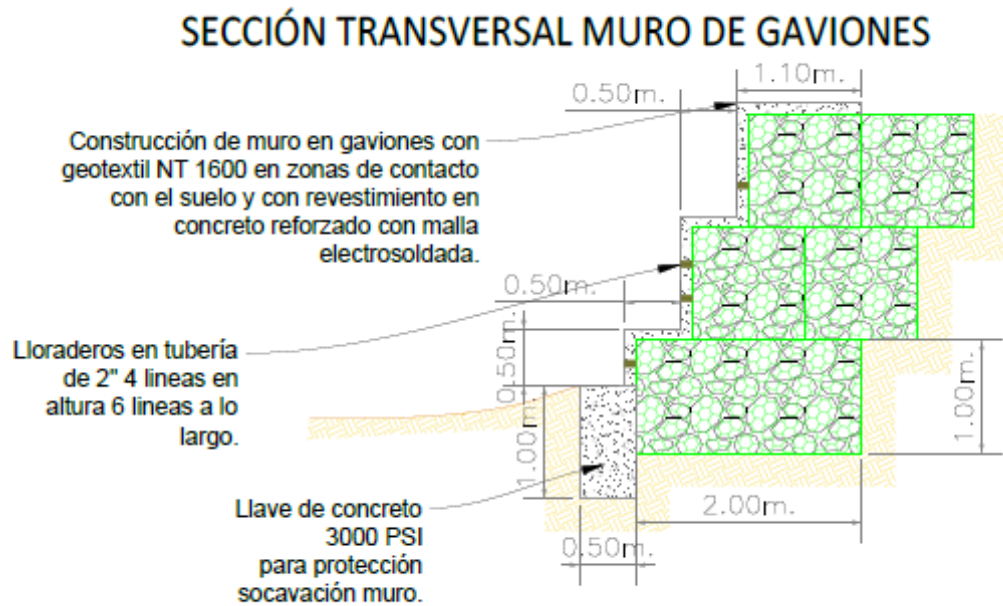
Sección transversal del muro de gaviones proyectado para la protección de la margen izquierda de la quebrada El Dindal.
